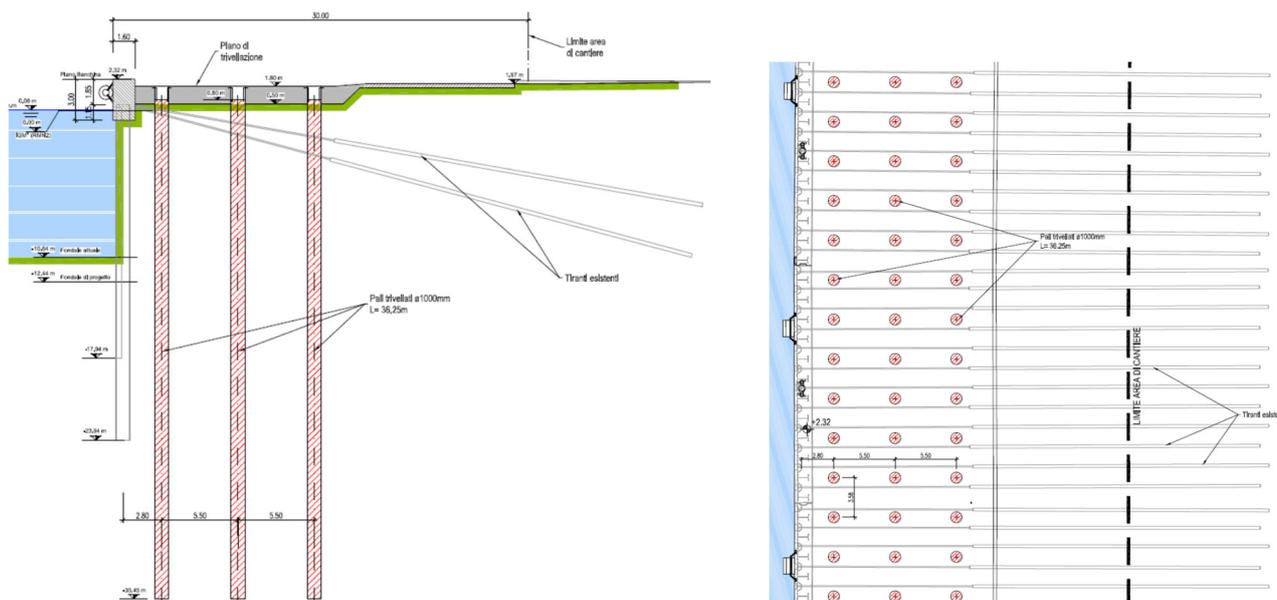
Banchina Trattaroli Nord Sud – Fase 4 – Sezione e planimetria
